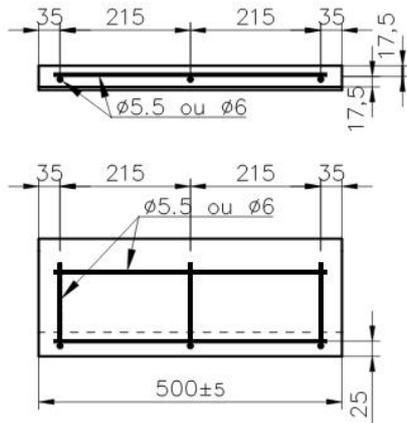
caniveau à câbles standard modèle 10,5 avec couvercle (dimensions en mm)
